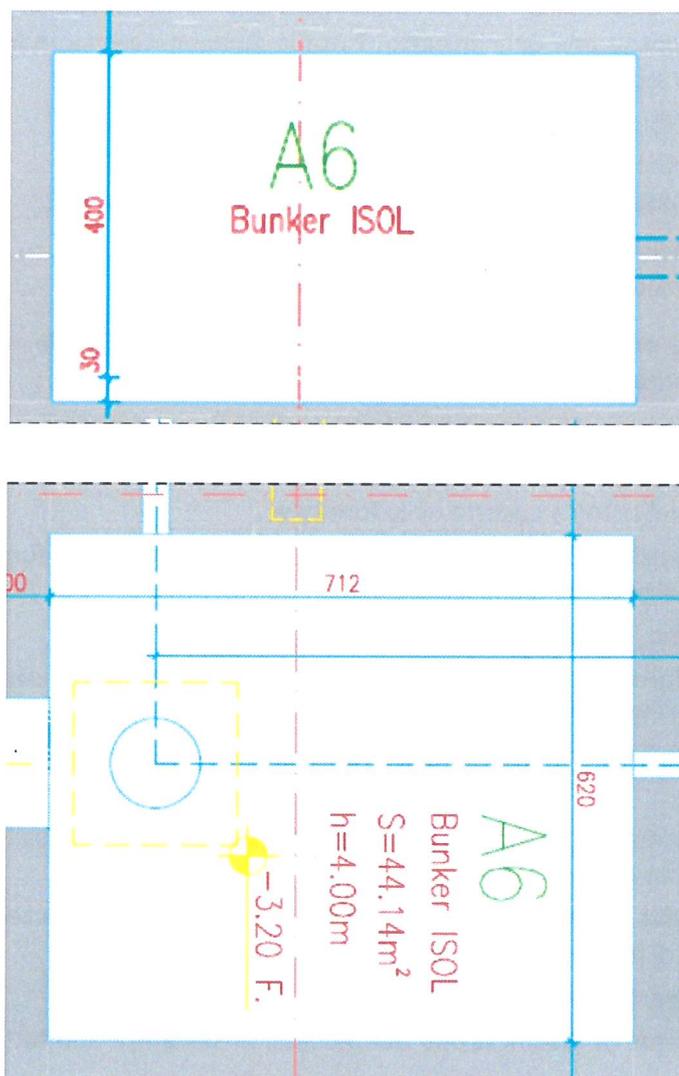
Prospetto e pianta del locale S018 (codice originario A6).
